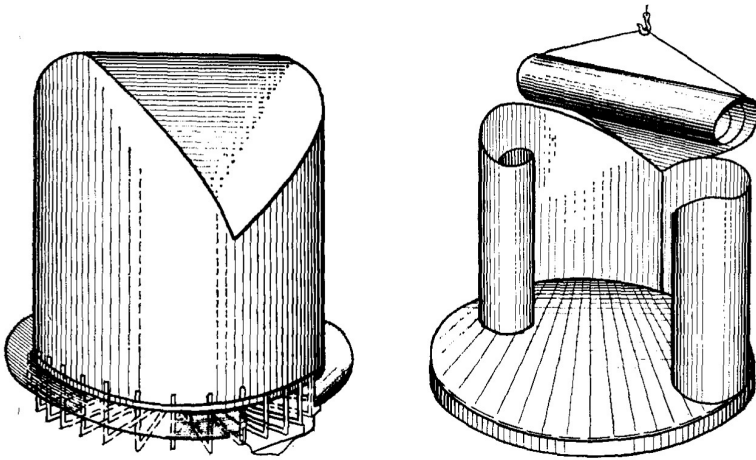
Вертикальный резервуар со сфероцилиндрической кровлей
